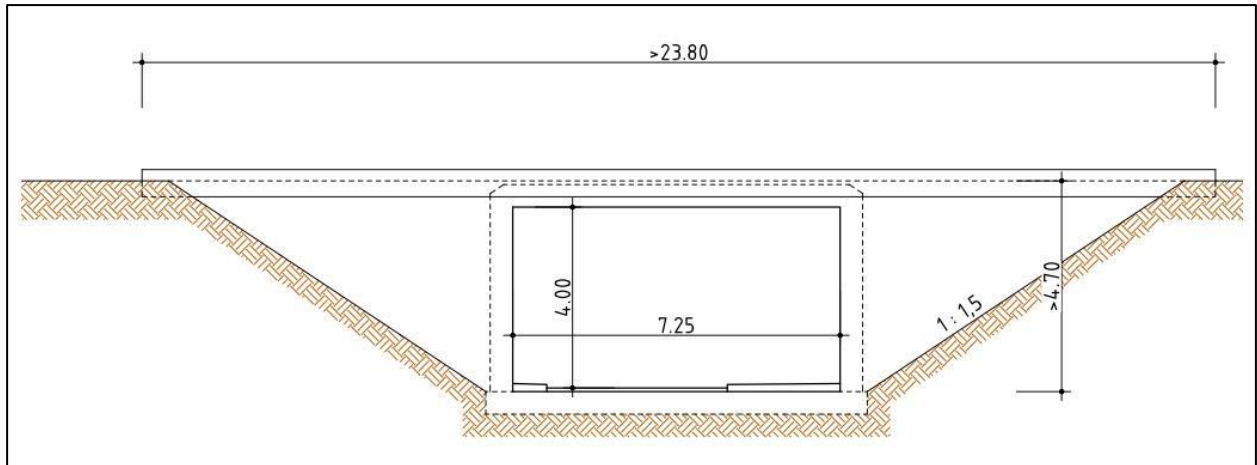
Ansicht Tunnelbauwerk BW 03 und BW 04
